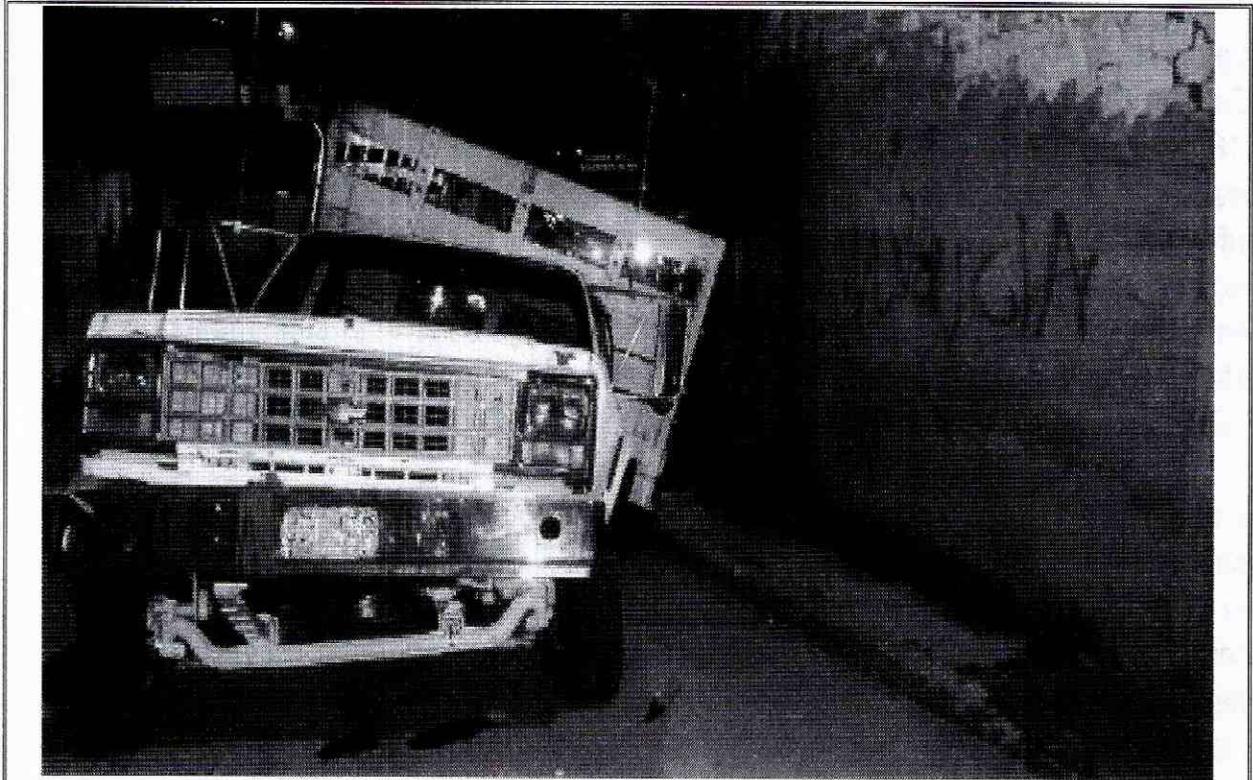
Volcamiento por falla en pavimento de la Carrera 4 con Calle 1 C; Sector Catastral Las cruces de la Localidad de Santa Fe (19/08/2016)
